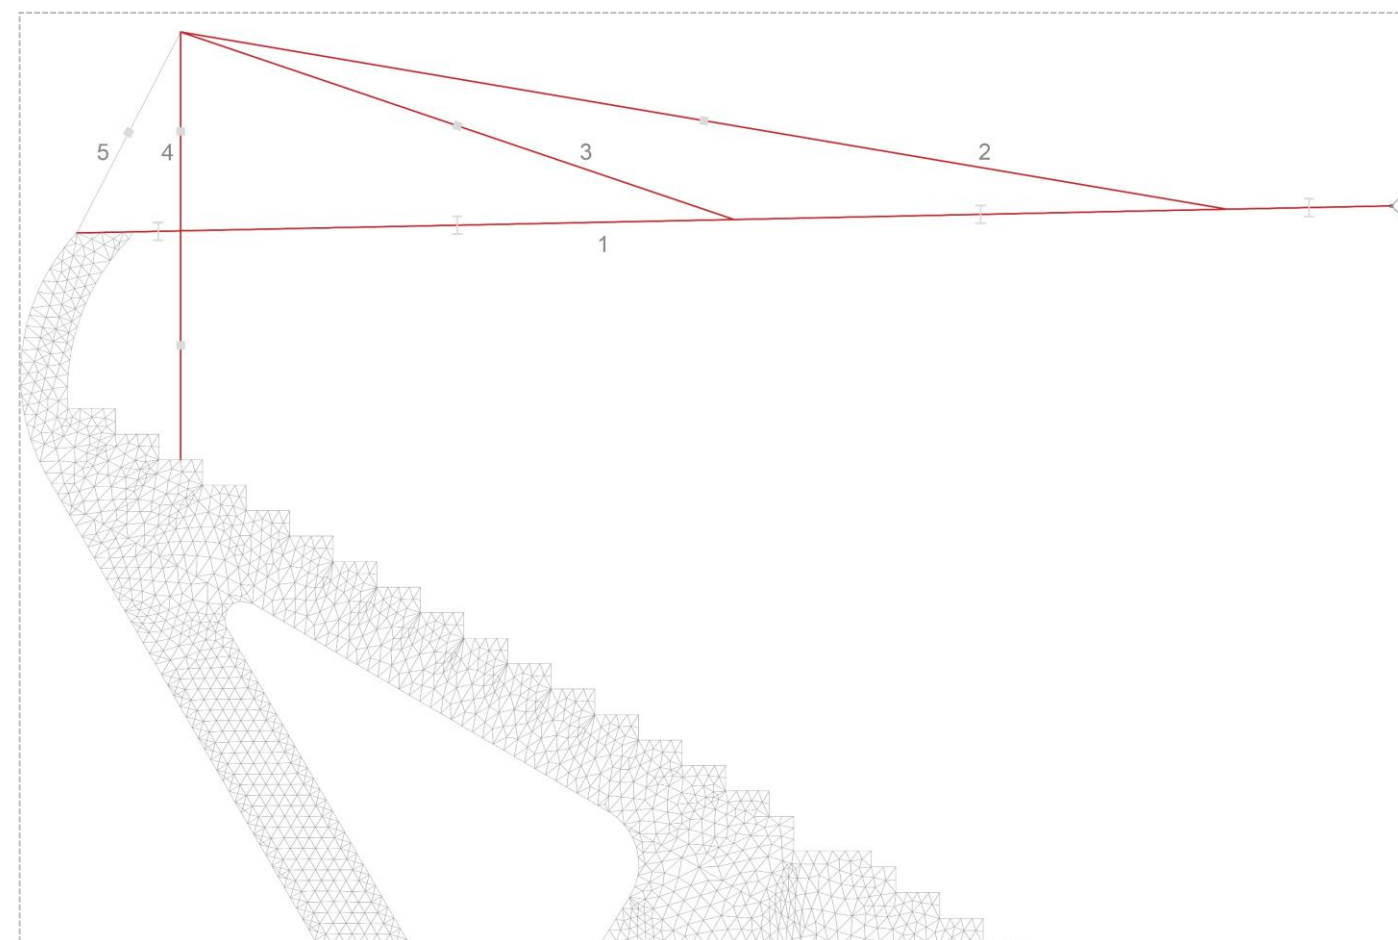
Extremo de voladizo. Apoyo deslizante en plano Z.
